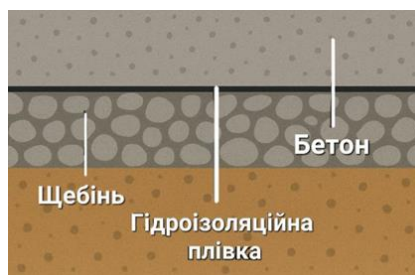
Розріз бетонування підлоги цокольного поверху
